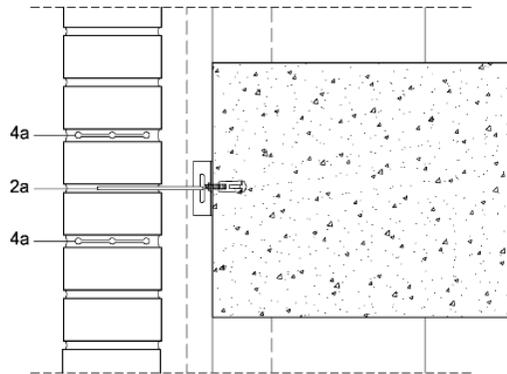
Sección vertical. Detalle de fijación de anclaje GEOANC® a forjado o pilar.
